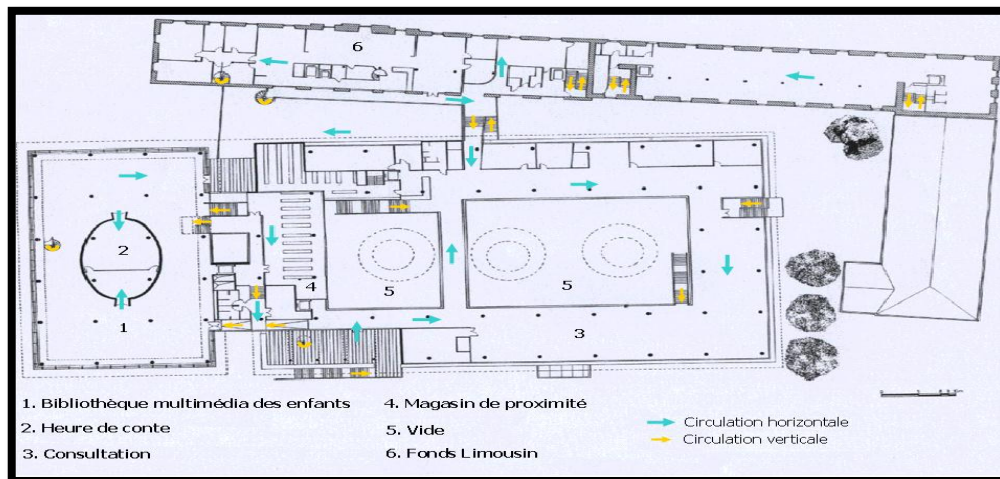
PLAN 1er étage (source : Pierre Riboulet)
